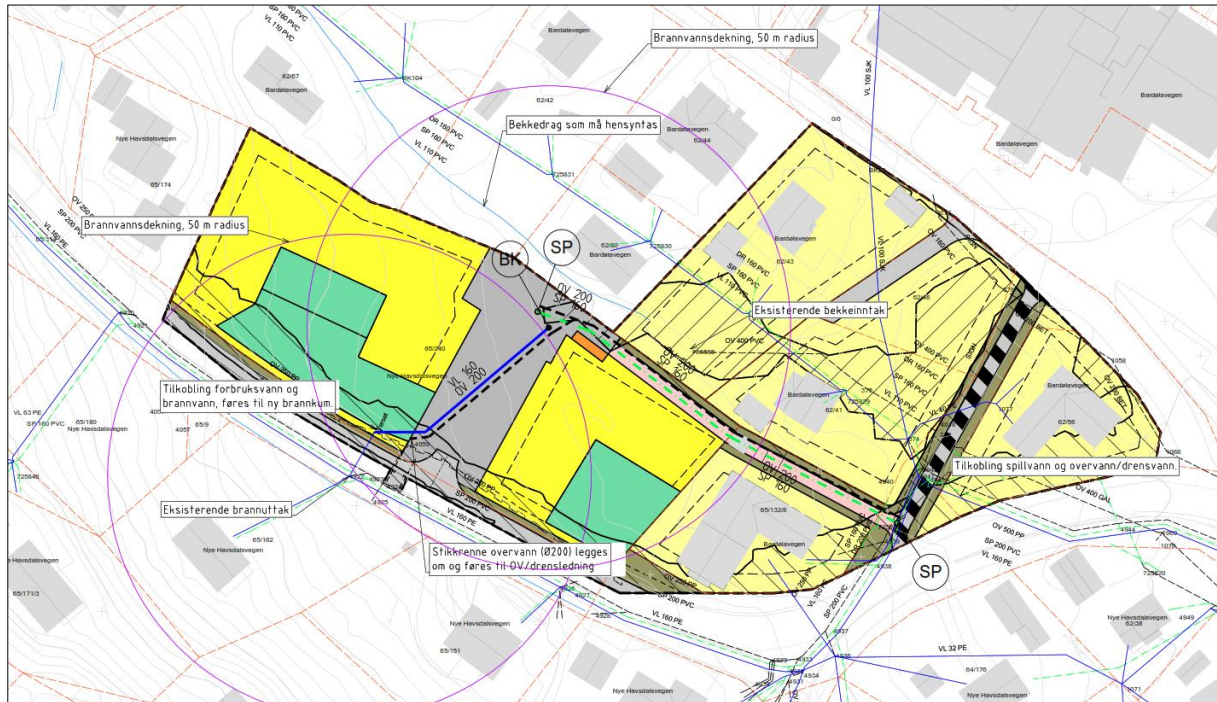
Illustrasjon av planlagt utbygging i planområdet.
